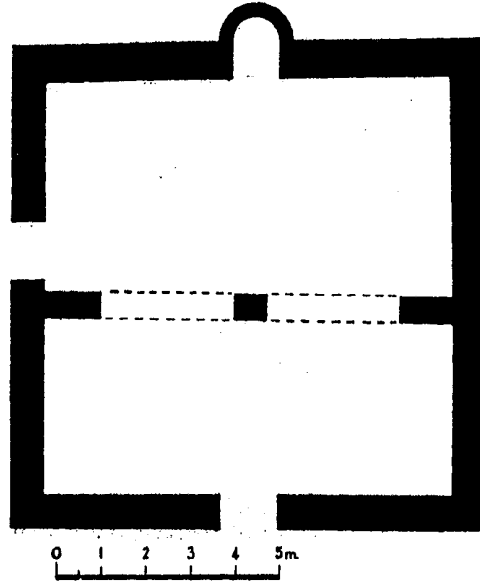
مسقط أفقي لجامع وقبة الشيخ خراسان في ازربيجان
